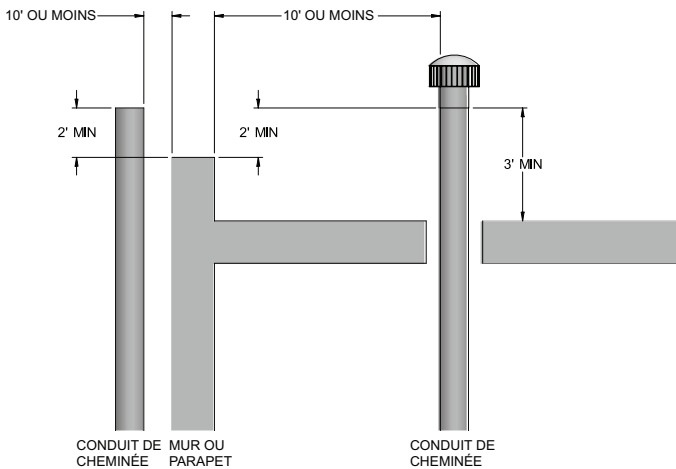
Terminaison de ventilation depuis un toit-terrasse - 10 pi. Ou moins du parapet
